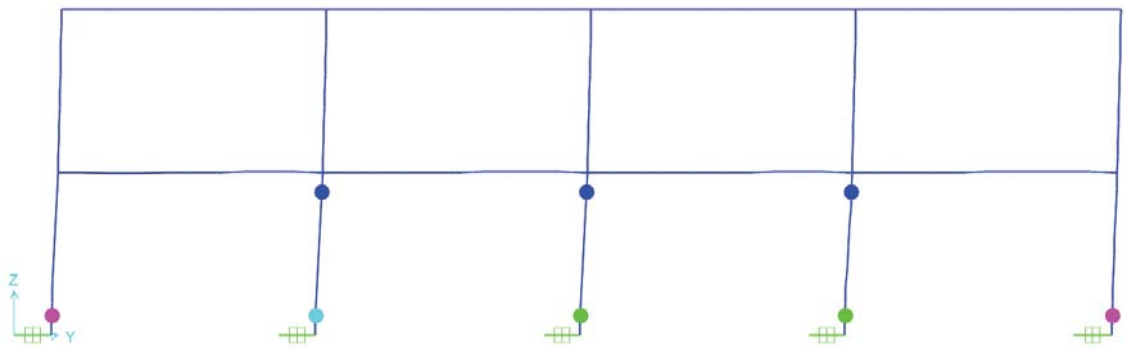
Secciones de columna en estado de Prevención del Colapso – Aislado
